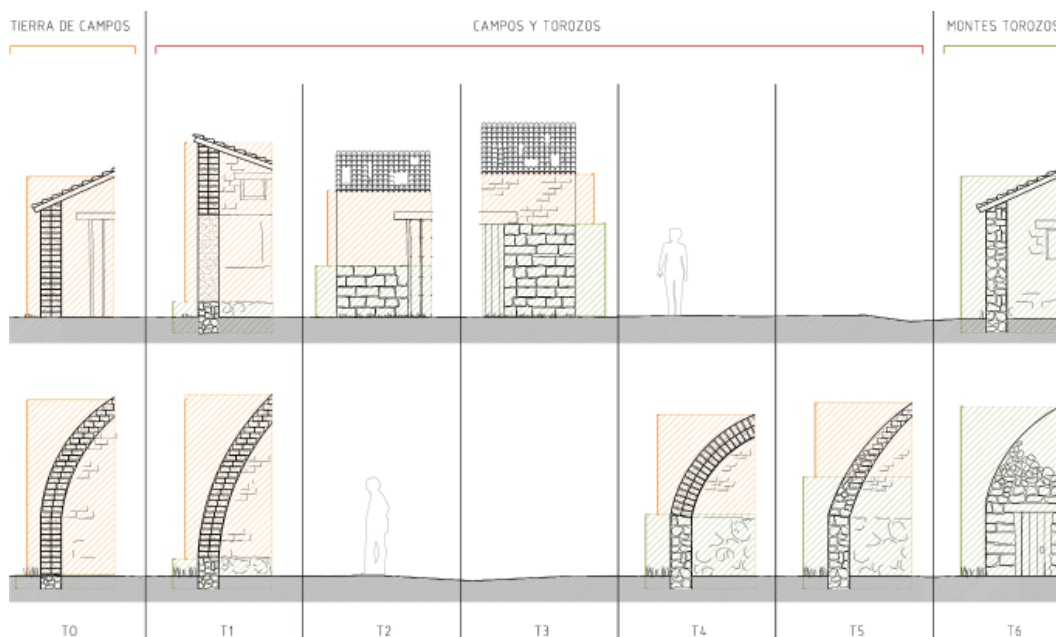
Clasificación tipológica de la transición tierra-piedra. En la fila superior aparecen las construcciones de cubierta inclinada, generalmente ejecutadas con estructura de madera. En la fila inferior aparecen aquellas con cubierta cupuliforme formada por tierra y/o piedra (O. Abril, 2013¹⁴).
